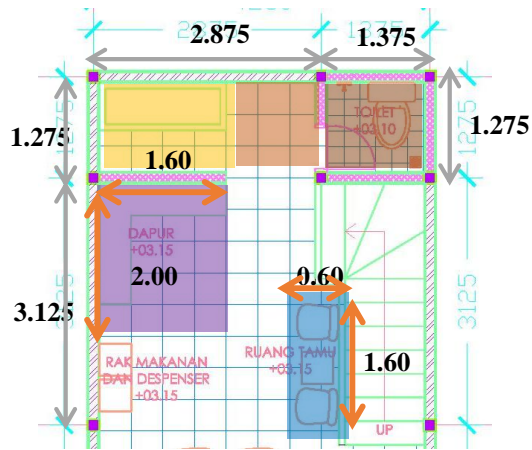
Denah Ruang Servis Lantai 1 Objek B
